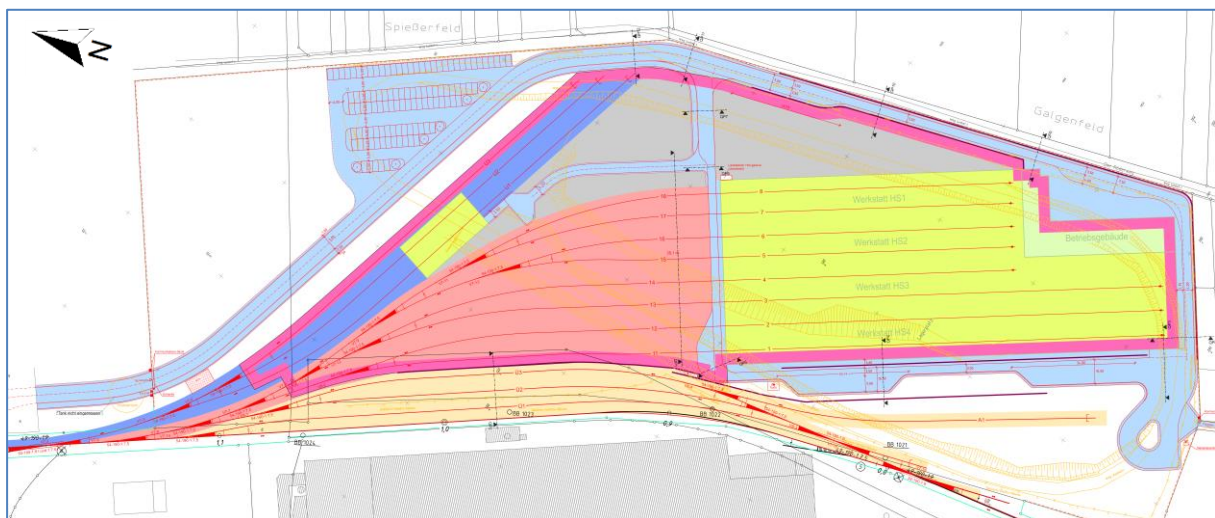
Übersichtslageplan mit Gebäuden, Gleisen und Verkehrsflächen
